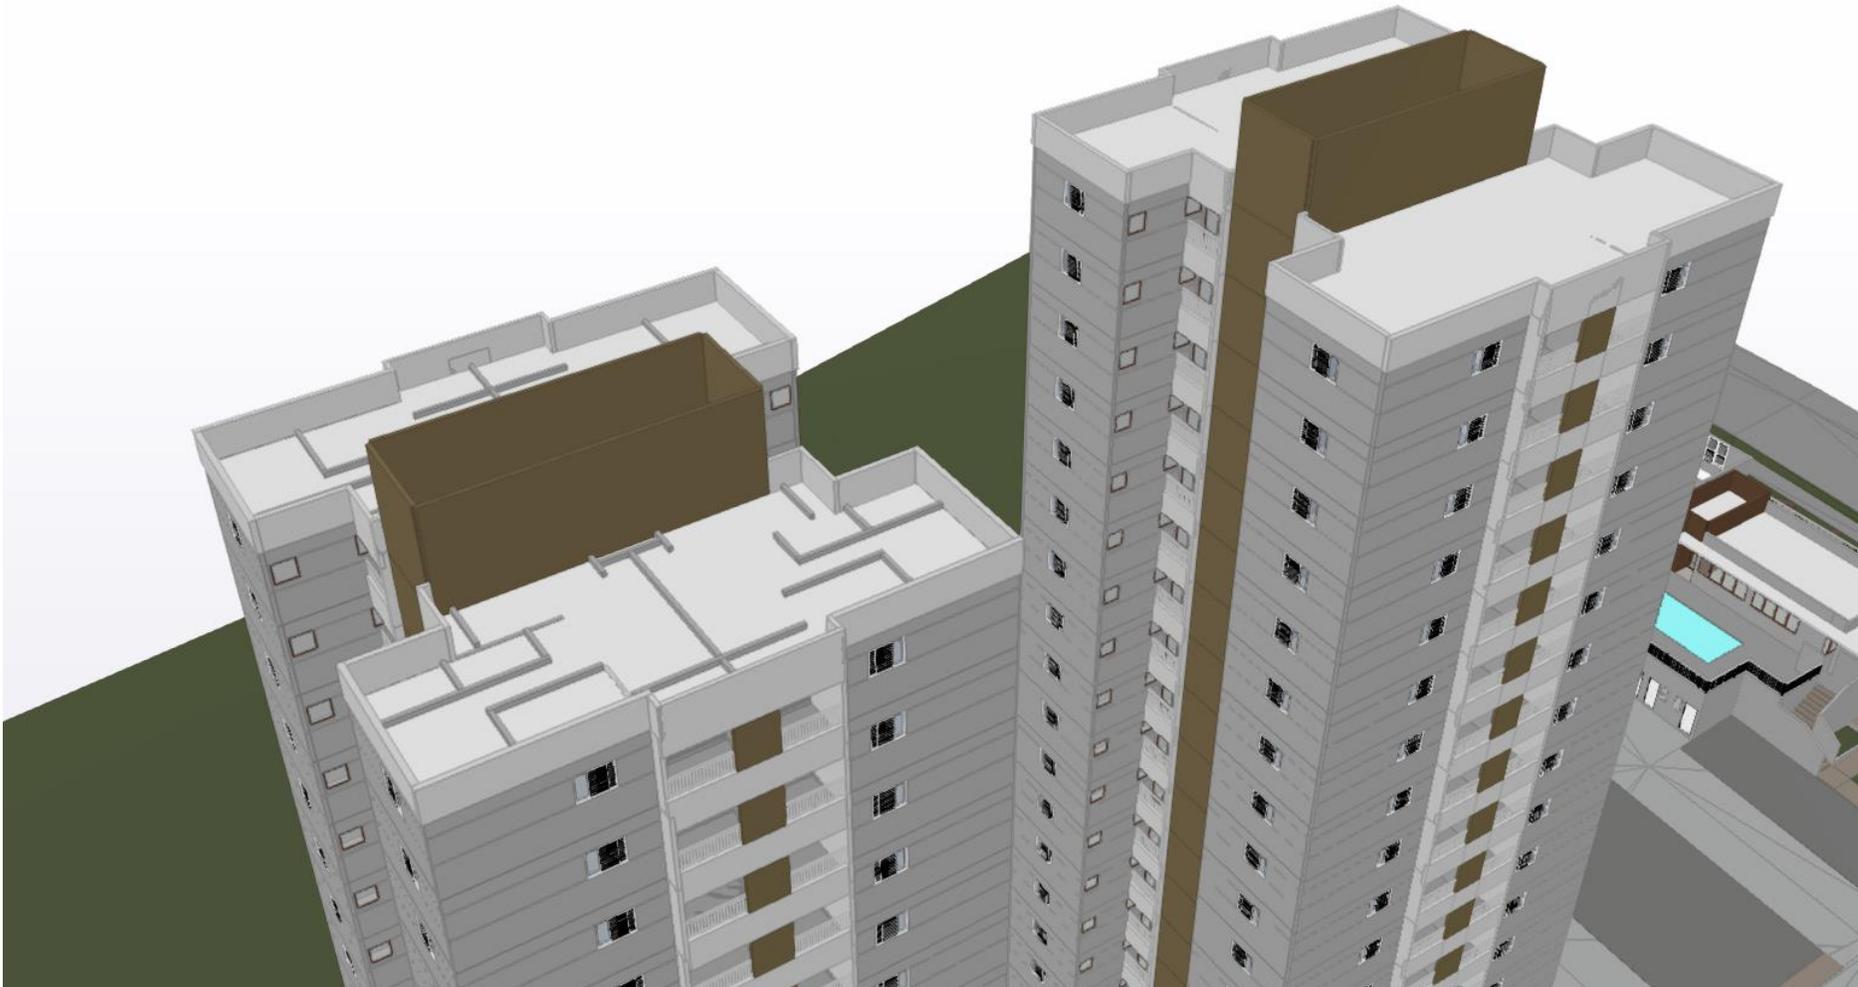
Ilustração Perfl I sobre andaime fixado na laje
